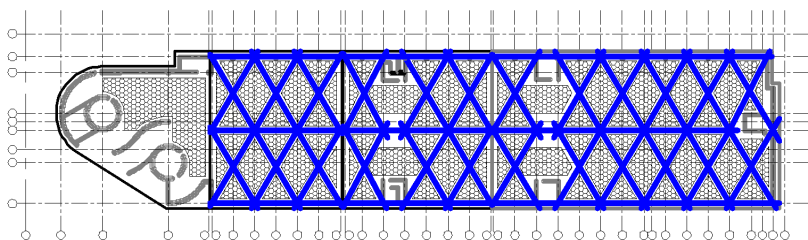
Вариант устройства облегченной предварительно напряженной фундаментной плиты с диагональным расположением канатов (показаны синим). На участках между армированными канатами полосами (фактически, скрытая в теле плиты балка) монтируются пустотообразователи (заштрихованы)
